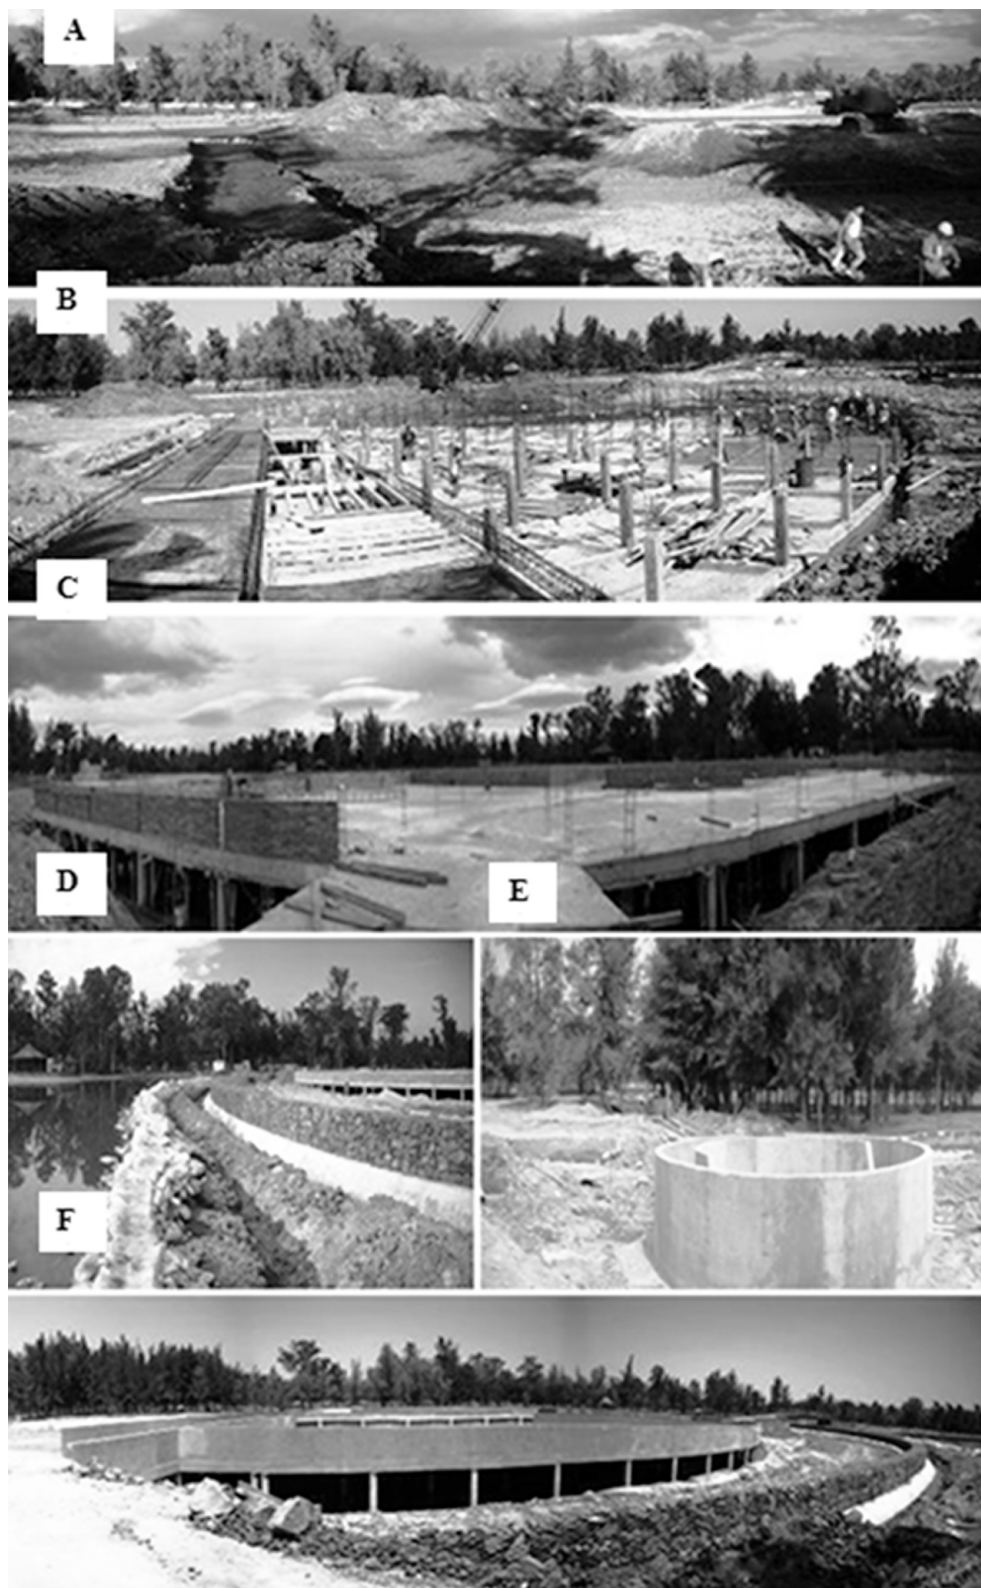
Construcción de la infraestructura externa: A) Preparación para la cimentación del HAFSS. B) Cimentación para los módulos del HAFSS. C) Construcción de los bordes perimetrales de los módulos del HAFSS. D) Construcción del muro gavión. E) Construcción del tanque sedimentador. F) Acabados del módulo del HAFSS.
